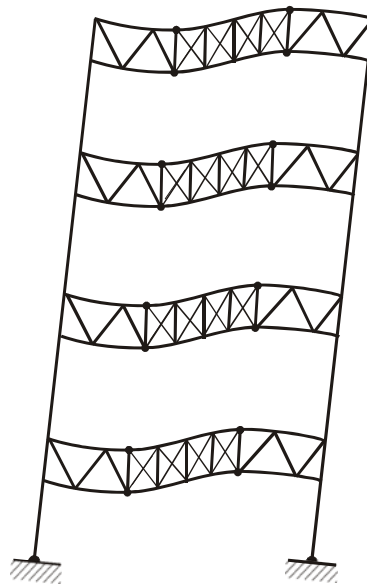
Pórtico no arriostrado con vigas reticuladas.
